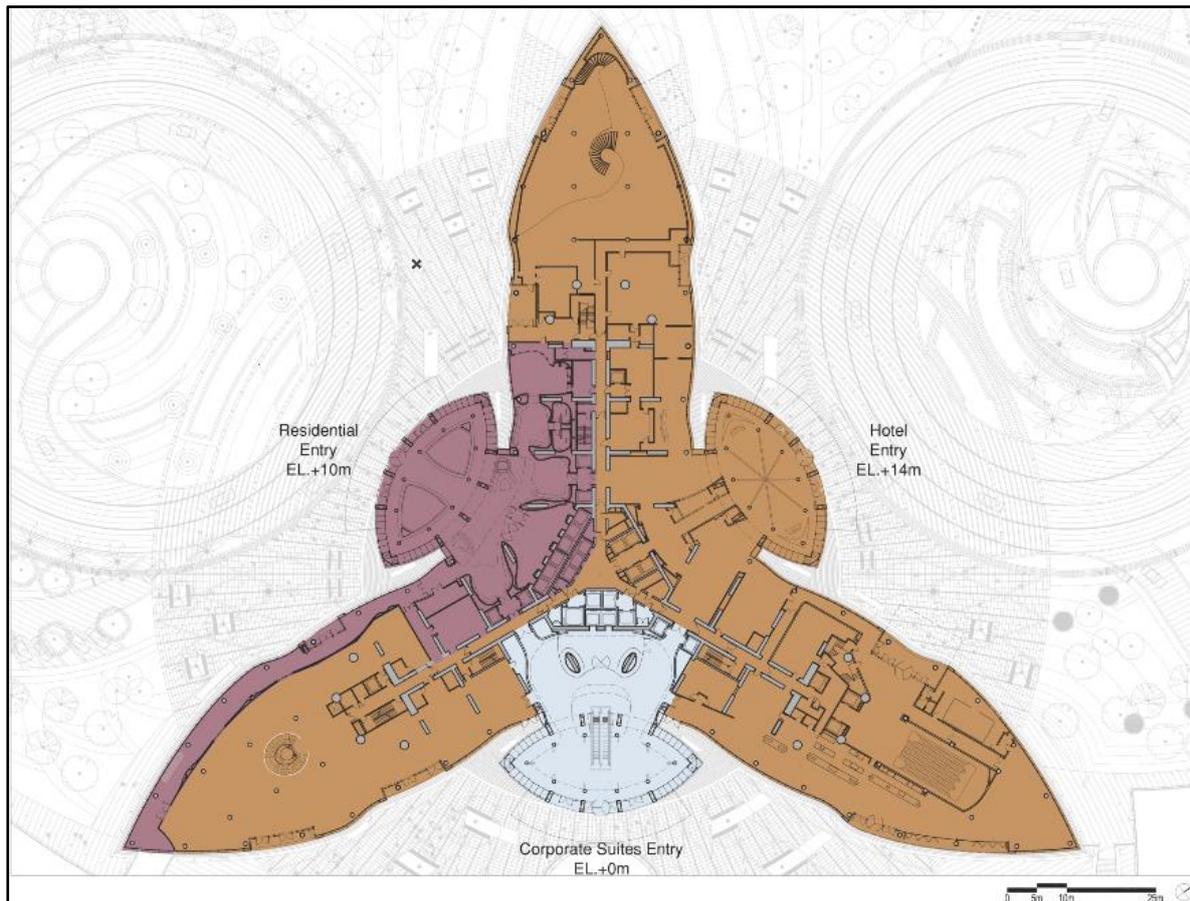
plan du rez de chaussée Burj Khalifa¹⁰⁰
